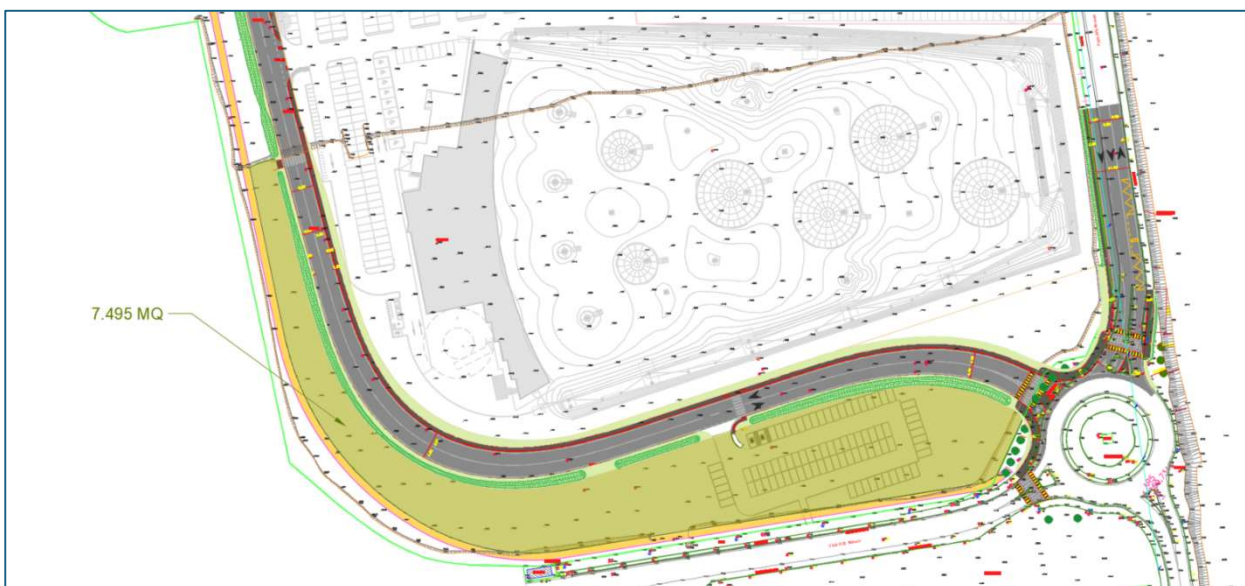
Planimetria rimodellazione area sudovest intervento N8
